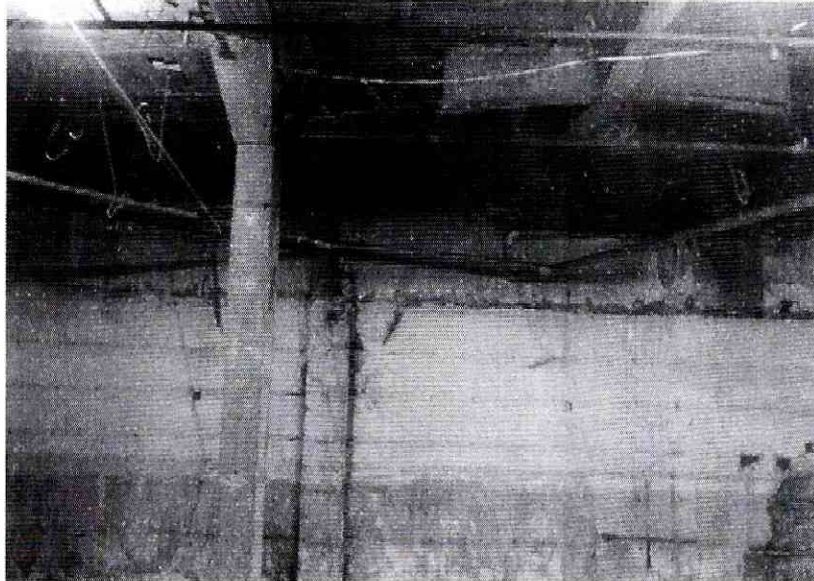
Vista general del inmueble ubicado en la Carrera 9 # 16 – 62.
